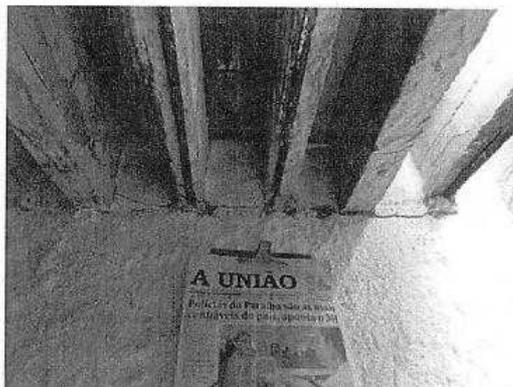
Fissuração horizontal no muro de divisa a nível de fundo das peças da pérgula. Ferragens oxidadas e expostas de peças da pérgula. Imagem mostra fundo da laje (bloco cerâmico) acrescida.
